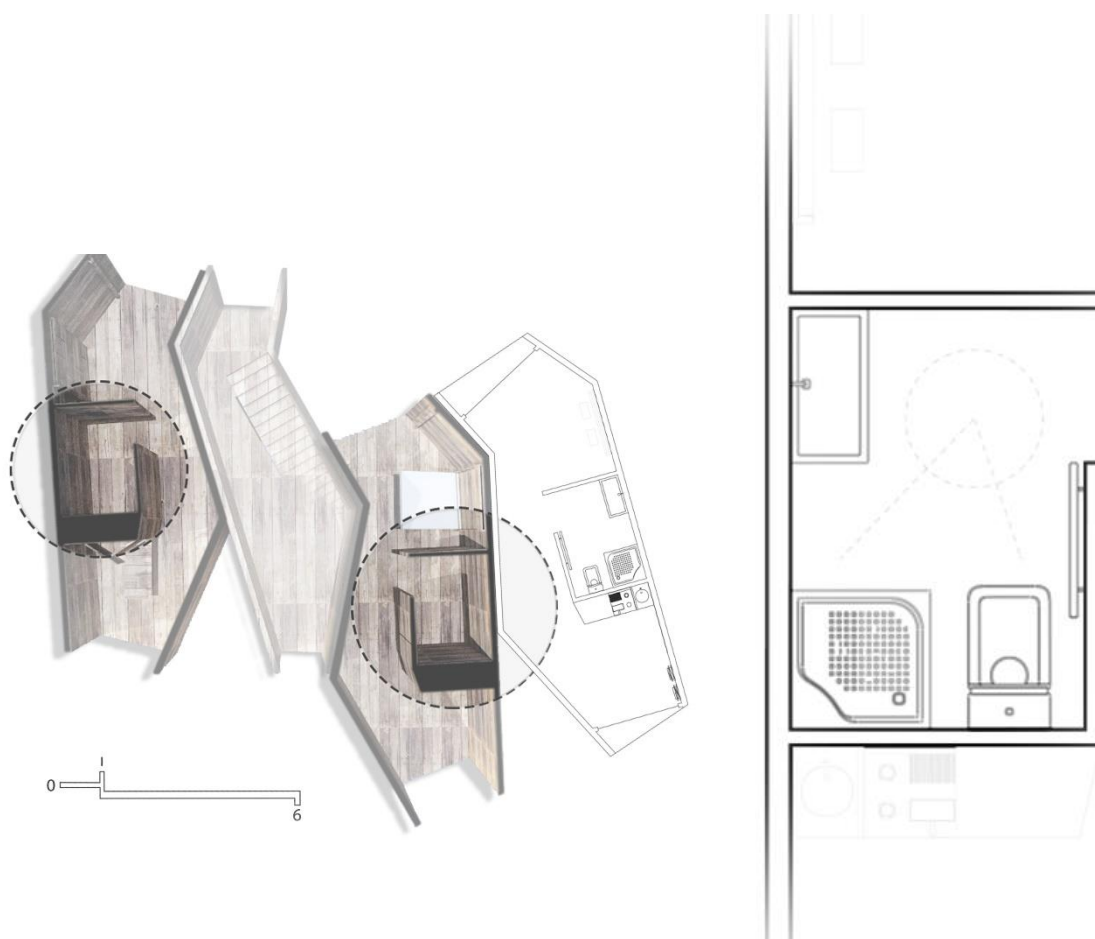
Planta da Instalação Sanitária e disposição espacial
